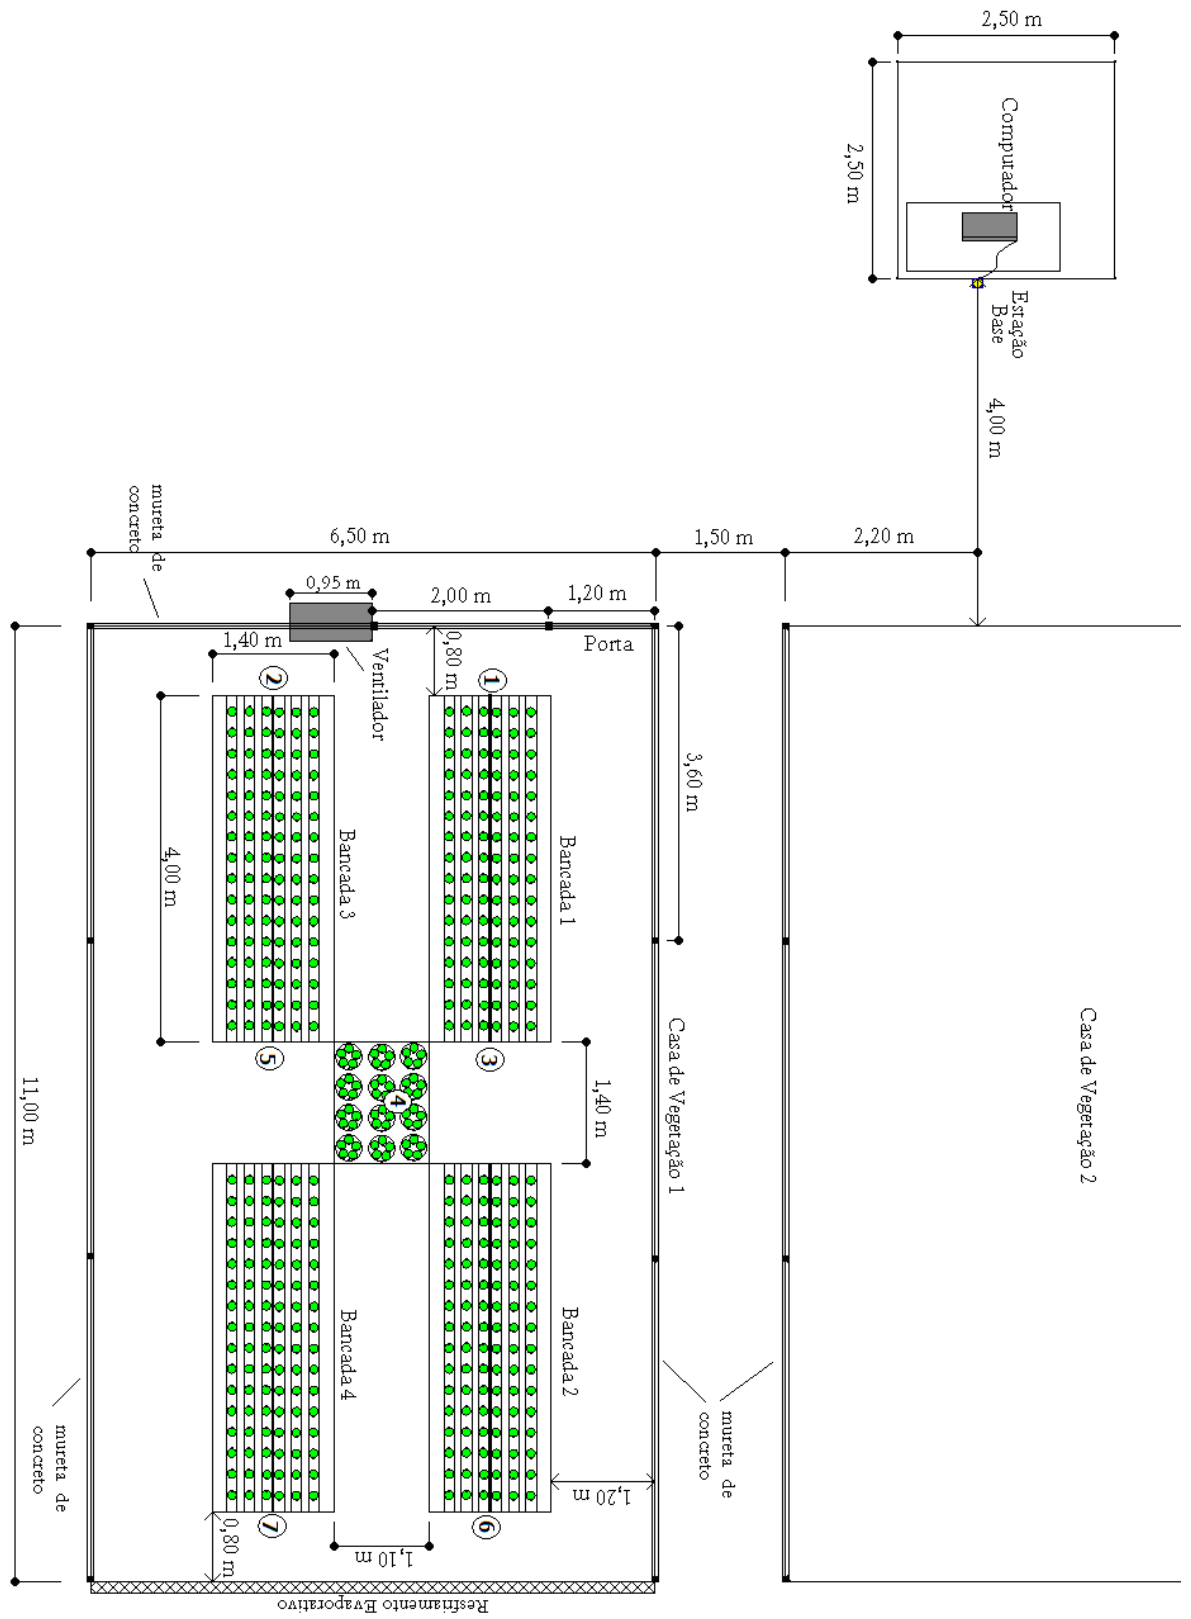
Planta Baixa da Casa de Vegetação e Área Externa
